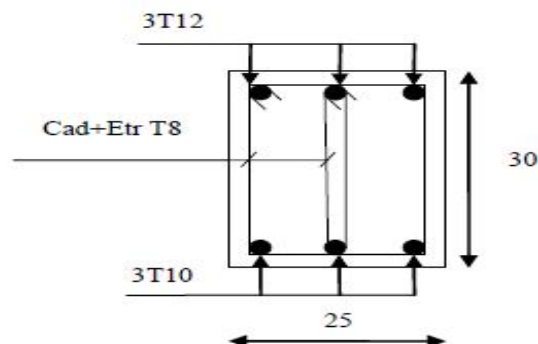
Ferrailage de la poutre de chainage.
